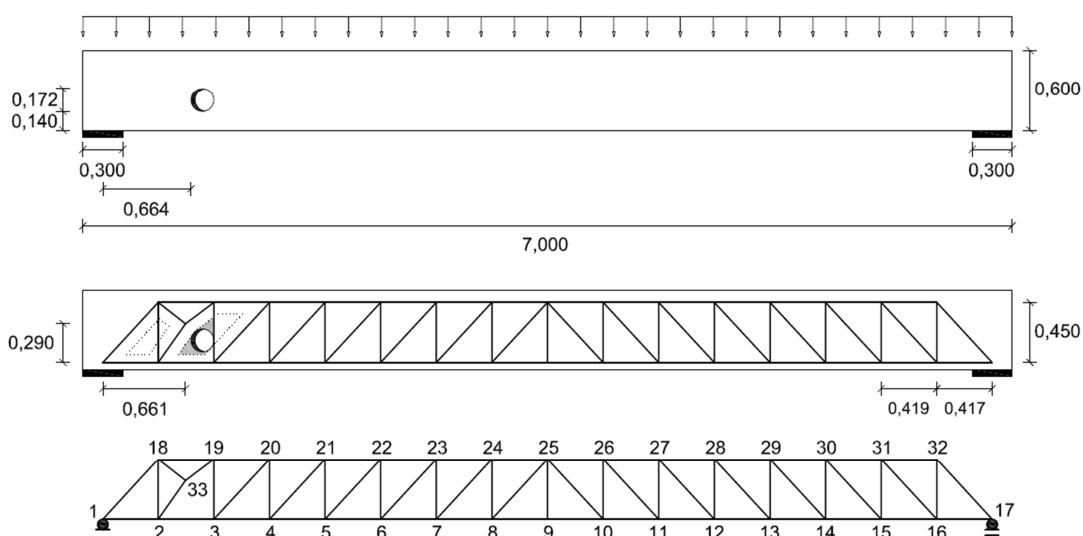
Elemento estrutural e treliça representativa (Viga 7) – Secção 0,60x0,30.
